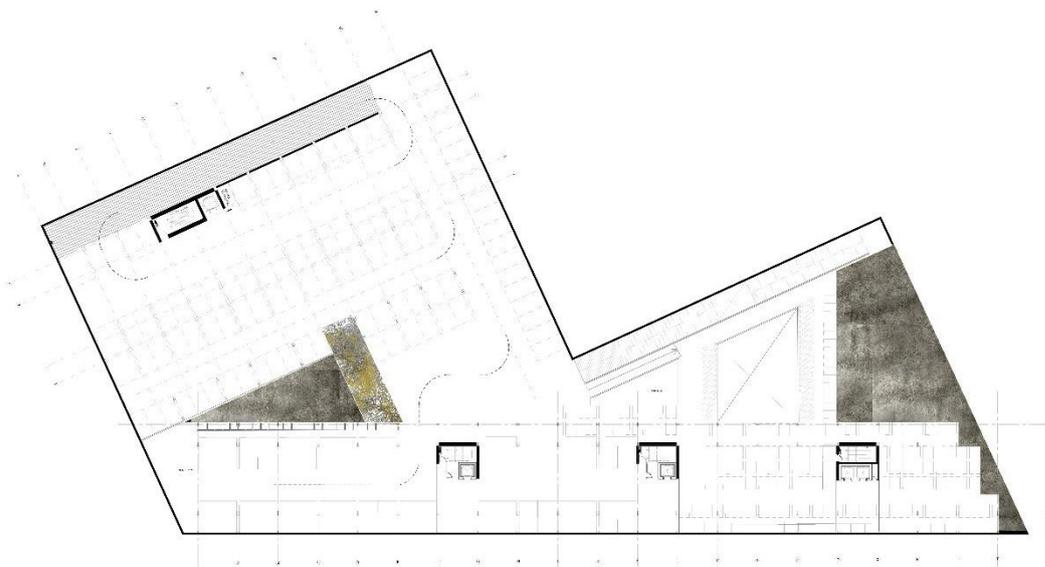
Planta de Subsuelo. Nivel - 3.00. Elaboración propia.
